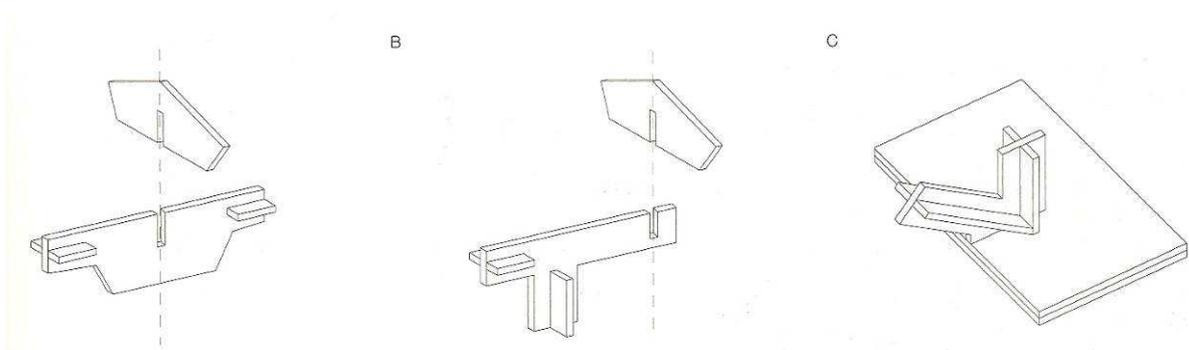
= Encaixes em madeira para conectar a estrutura
